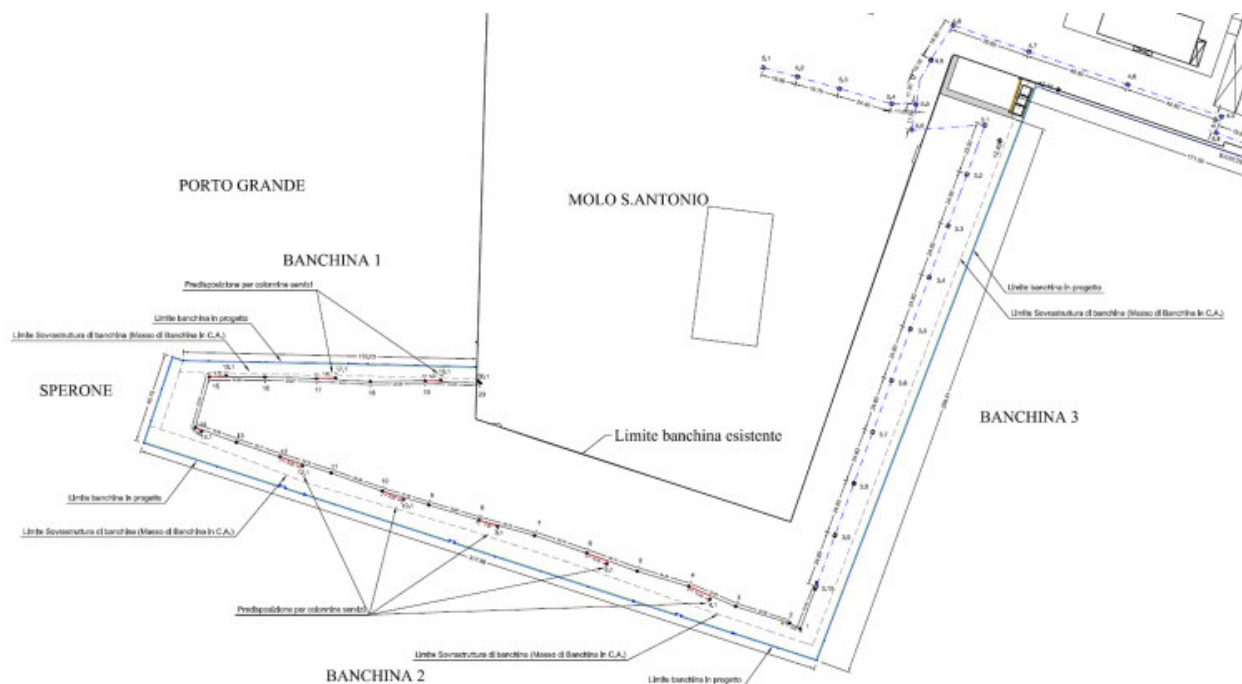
Stralcio planimetria EEG10016T2381/21- Banchina 2 e 3
